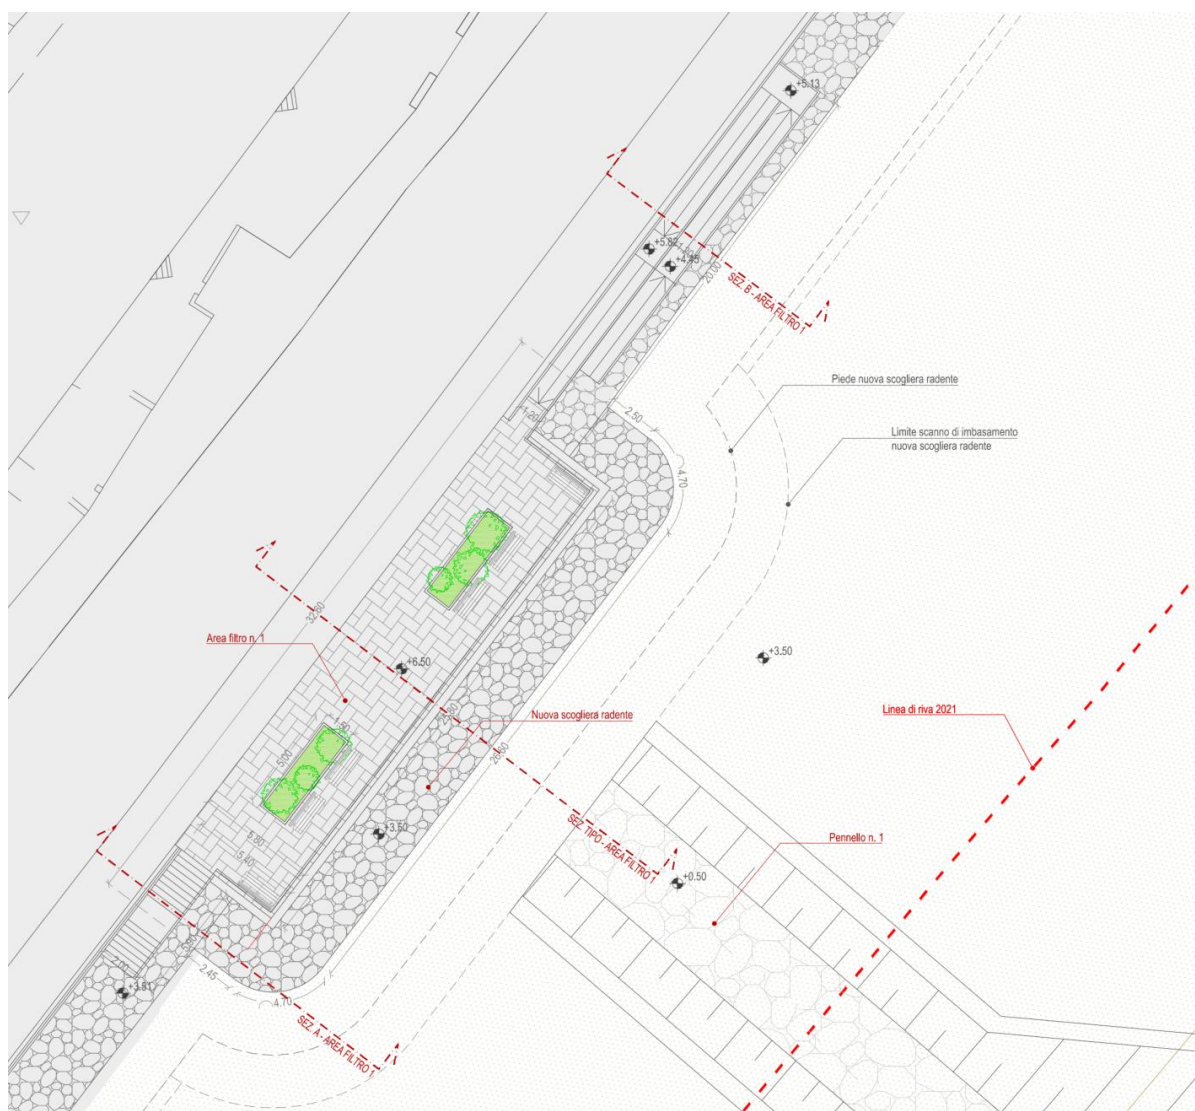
Planimetria generale aree filtro (rif. Area filtro n. 1)
